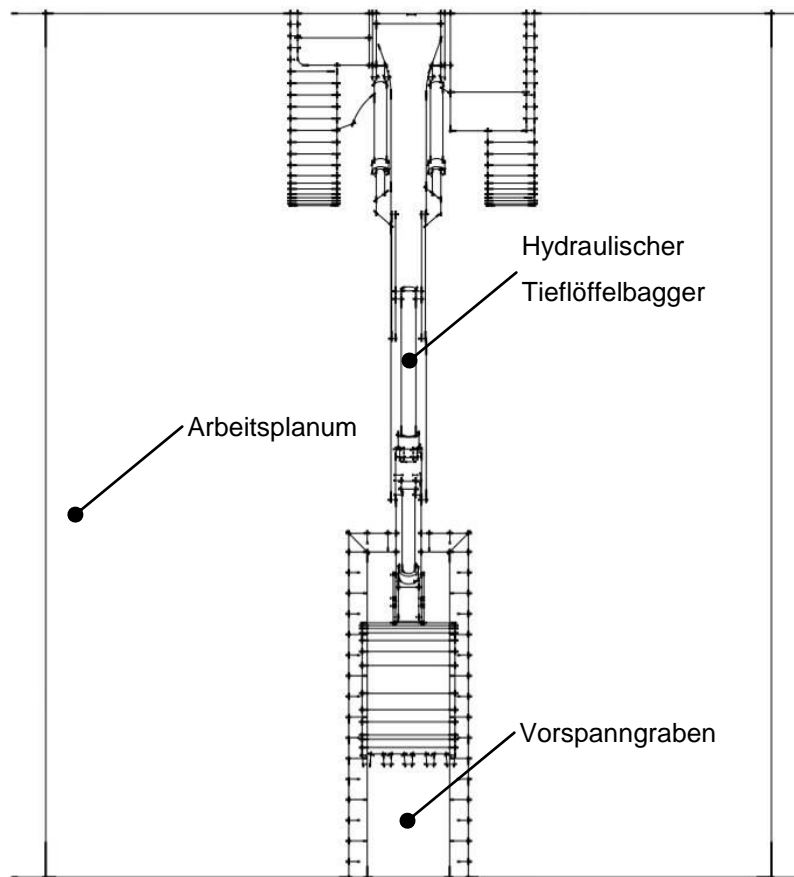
Erstellen des Vorspanngrabens – Grundriss
